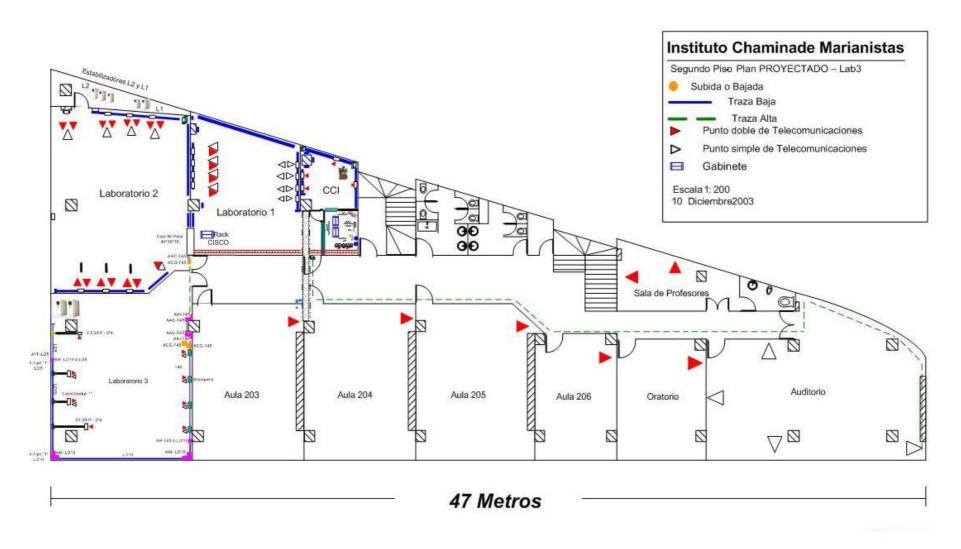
Plano del segundo piso del Instituto Chaminade Marianistas
